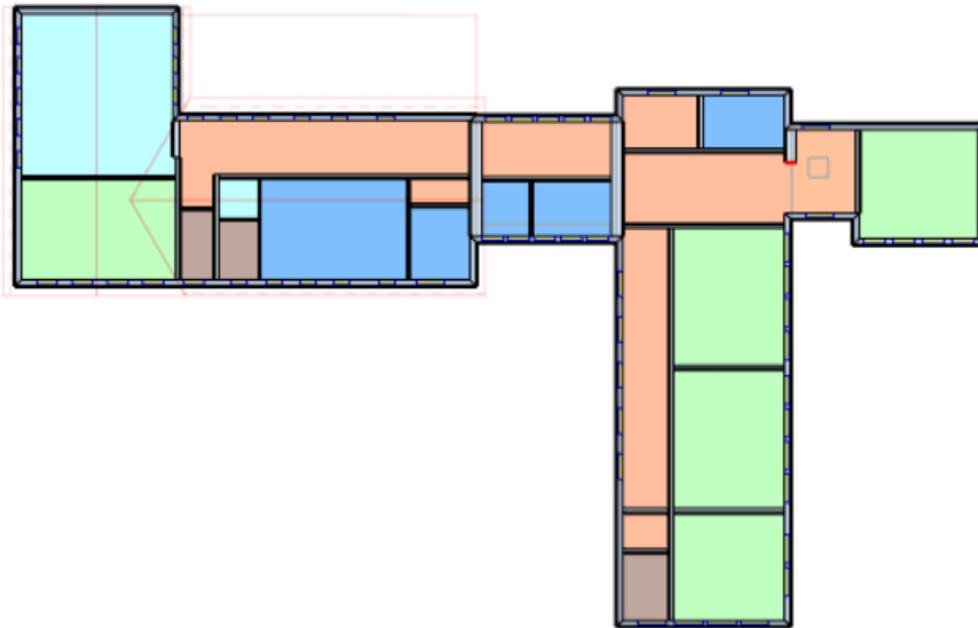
Grundriss Obergeschoss, zониert
